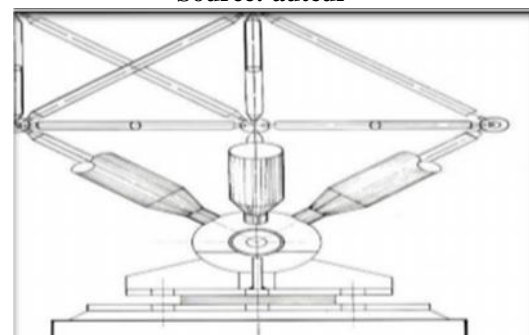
articulation poutre tridimensionnelle poteaux métallique
